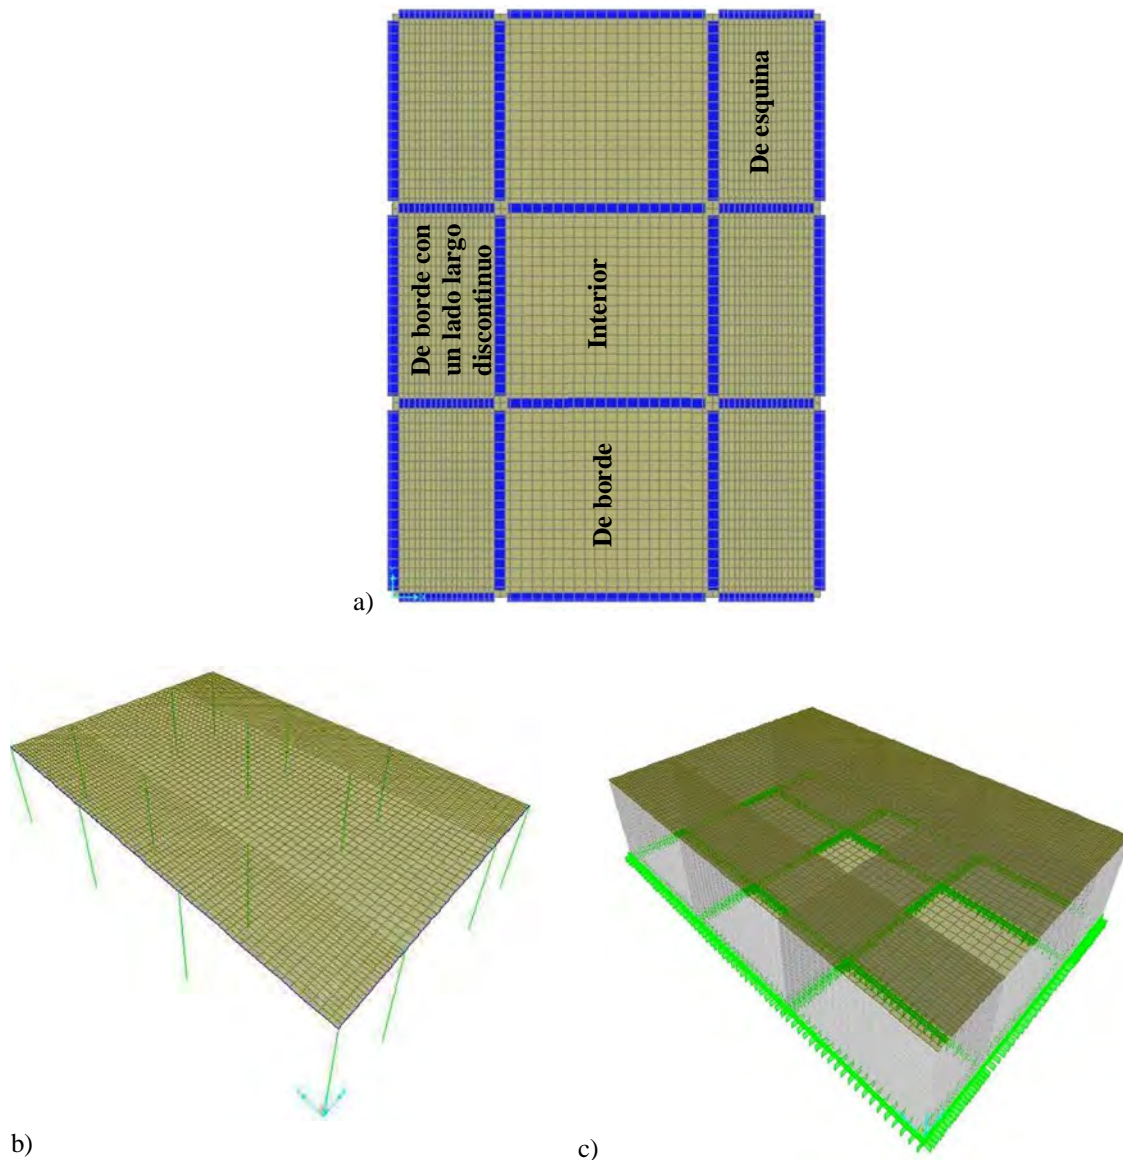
Modelo para tableros de esquina y de borde con un lado largo discontinuo: a) planta, b) apoyados sobre vigas y b) sobre muros.
